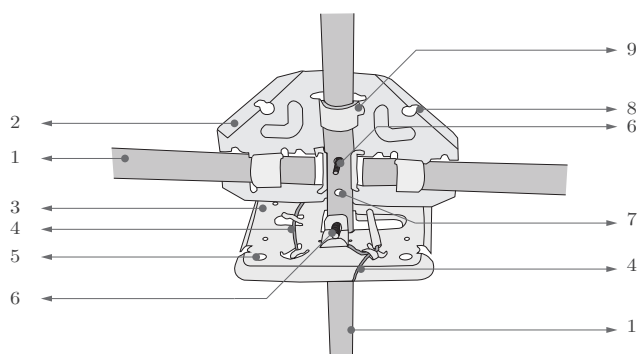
Detalle del ensamblaje cuádruple de la estructura de RHU. Fuente: Vargas (2011).
